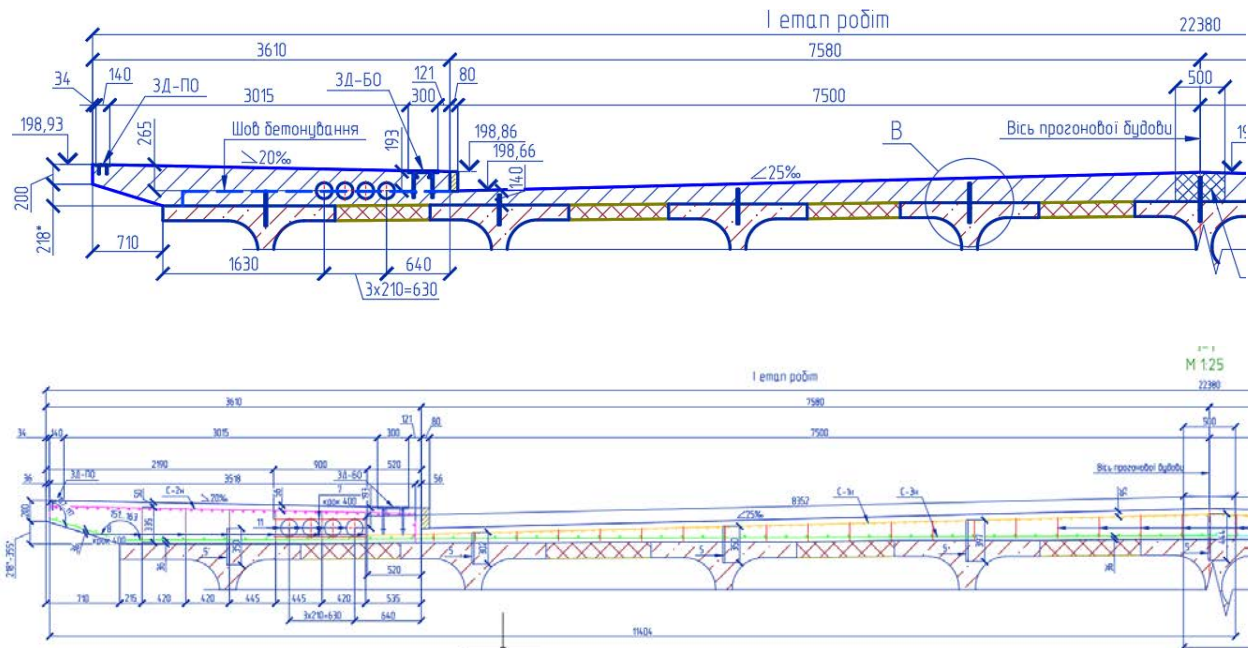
Опалубне і арматурне креслення монолітної плити.
